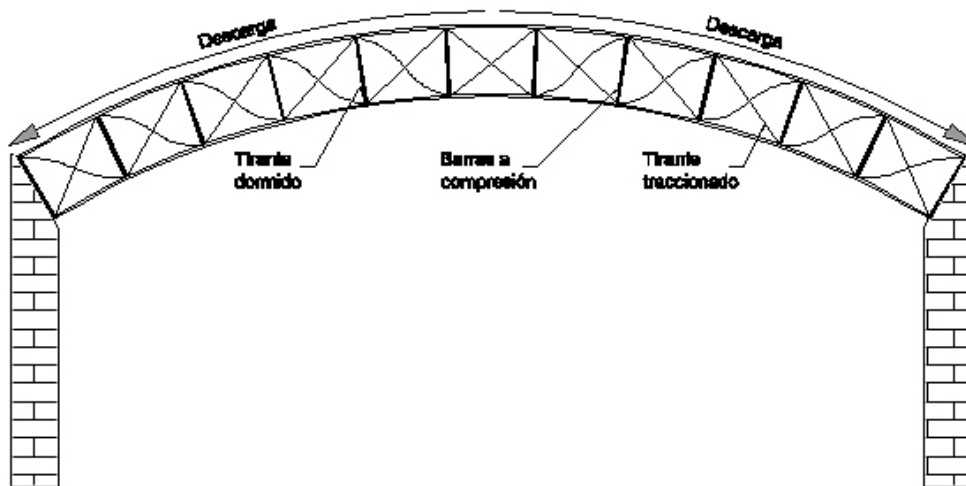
Diseño de armadura de madera posiblemente utilizada como cimbra para puentes de mampostería finales del siglo XV. Fuente: Autores
